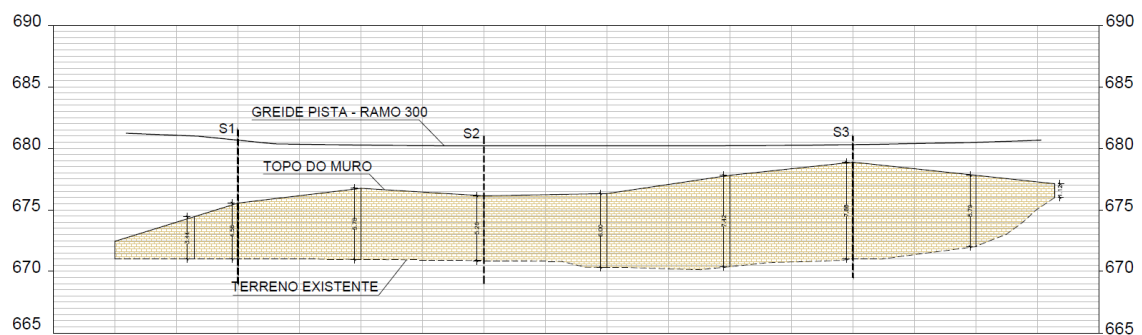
Elevação do muro de contenção e posicionamento das seções de cálculo.
